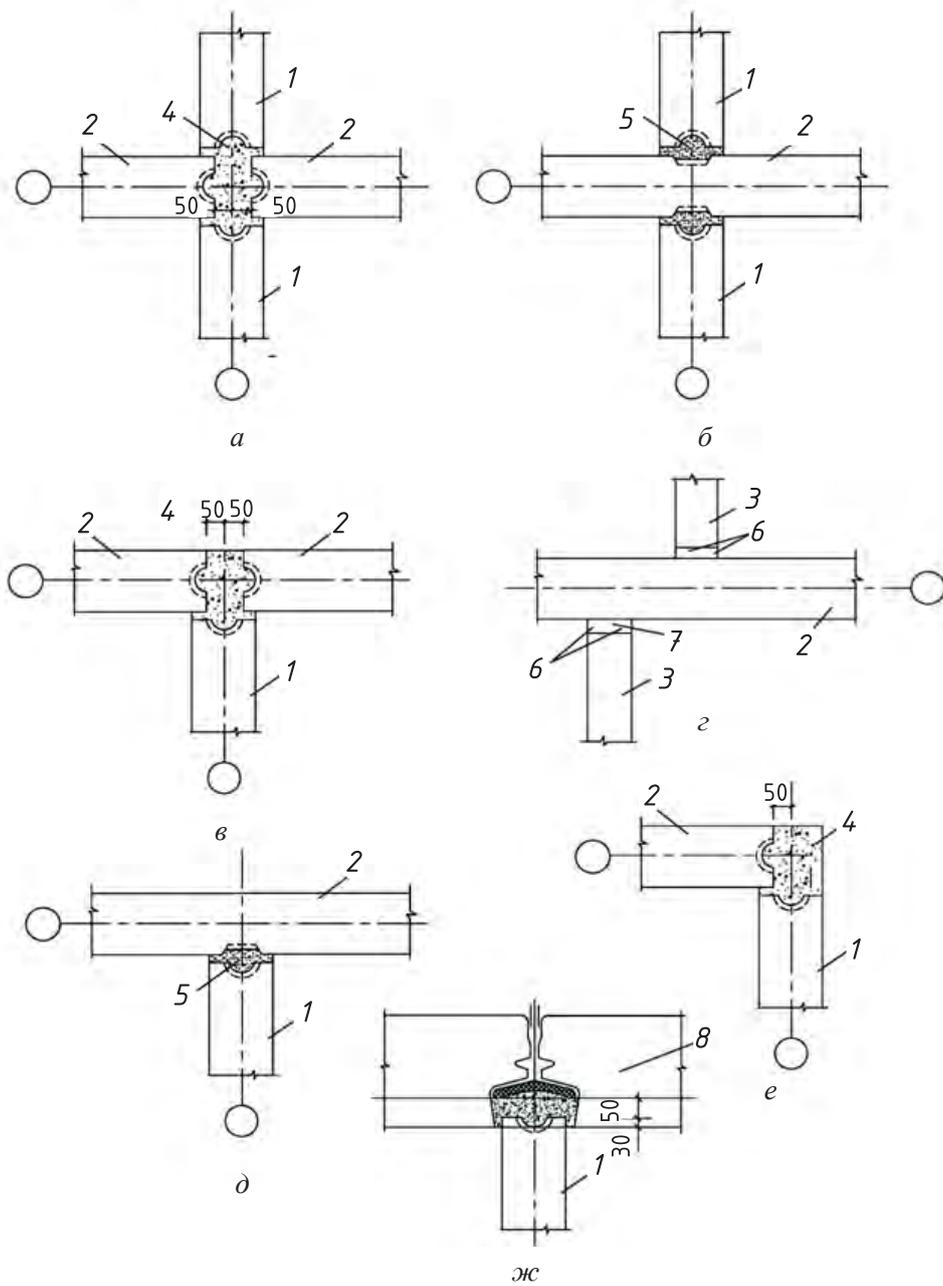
Вертикальные стыки панелей внутренних стен и перегородок: *а–е* — стыки несущих панелей между собой и с наружной стеной; *ж* — стык несущих перегородок со стеновой панелью: *1* и *2* — панели поперечных и продольных внутренних стен; *3* — панель перегородки; *4* — бетон замоноличивания; *5* — шпоночные рифления стыковых граней панелей; *6* — упругие прокладки; *7* — раствор; *8* — панель наружной стены
